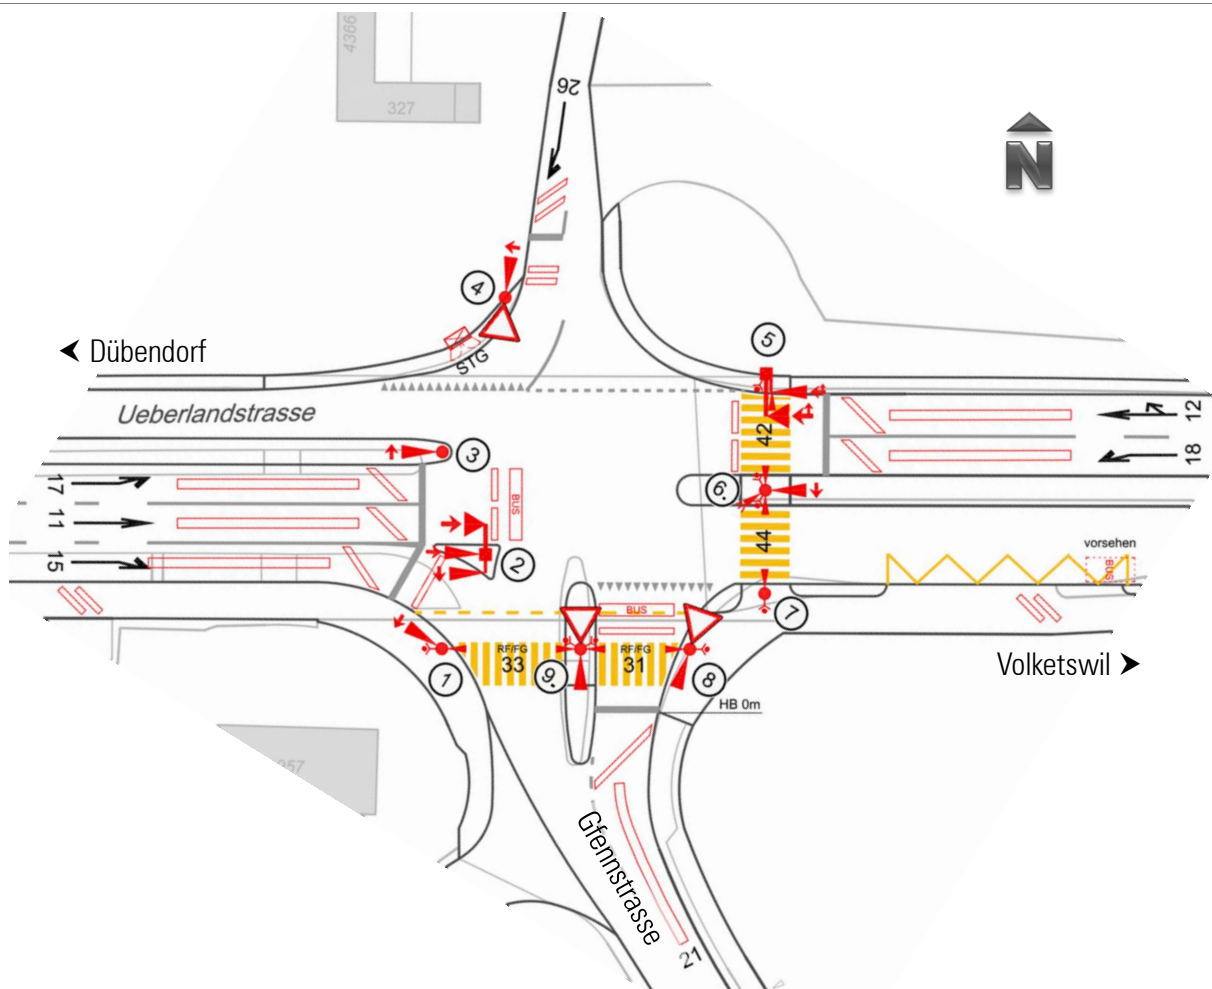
Ausschnitt Signallageplan LSA Ueberland-/ Gfennstrasse
